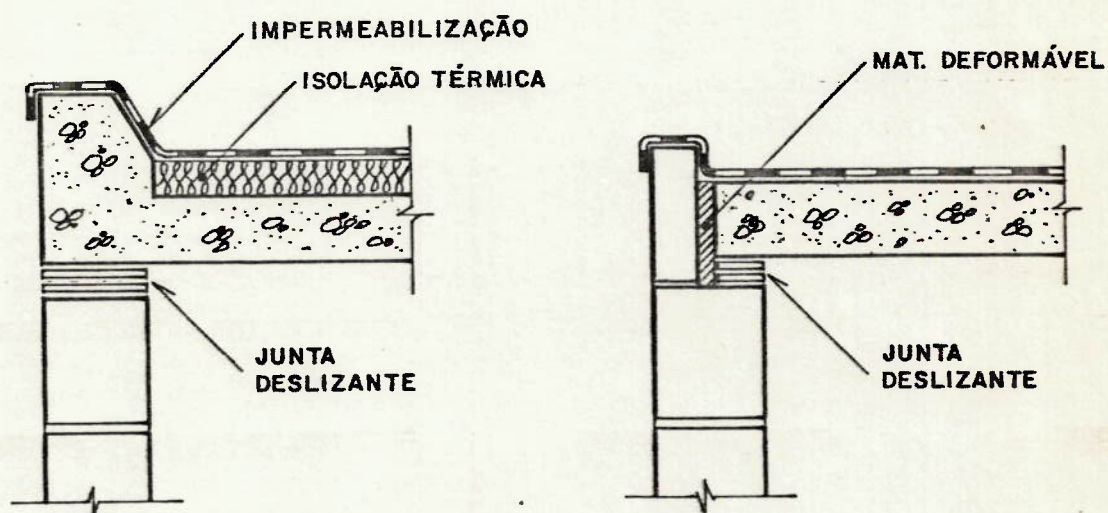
Junta deslizante entre laje de cobertura e alvenaria estrutural
